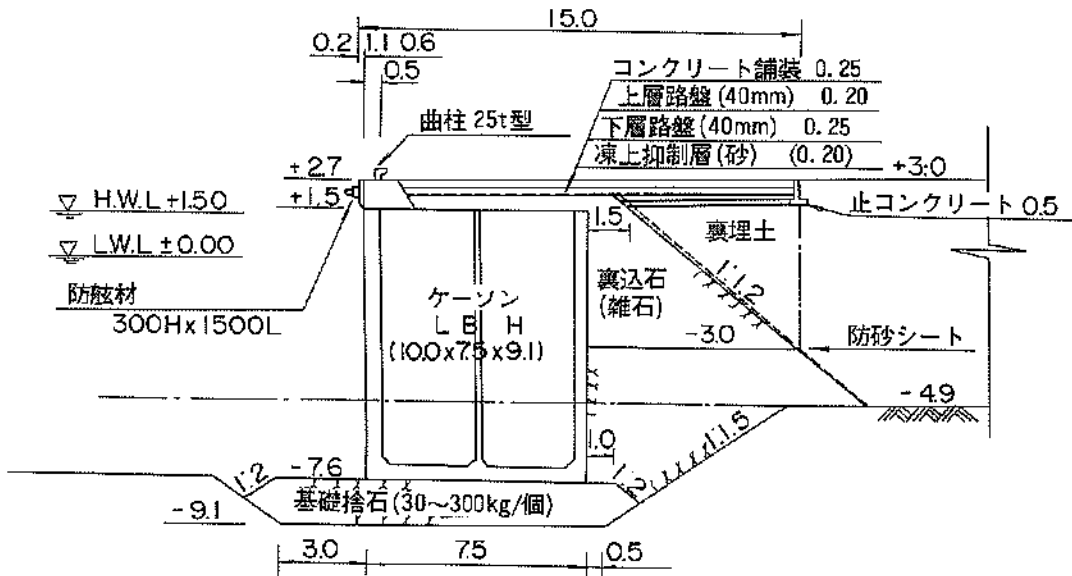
標準断面図 (十勝港, ②岸壁(南-5.5m))
